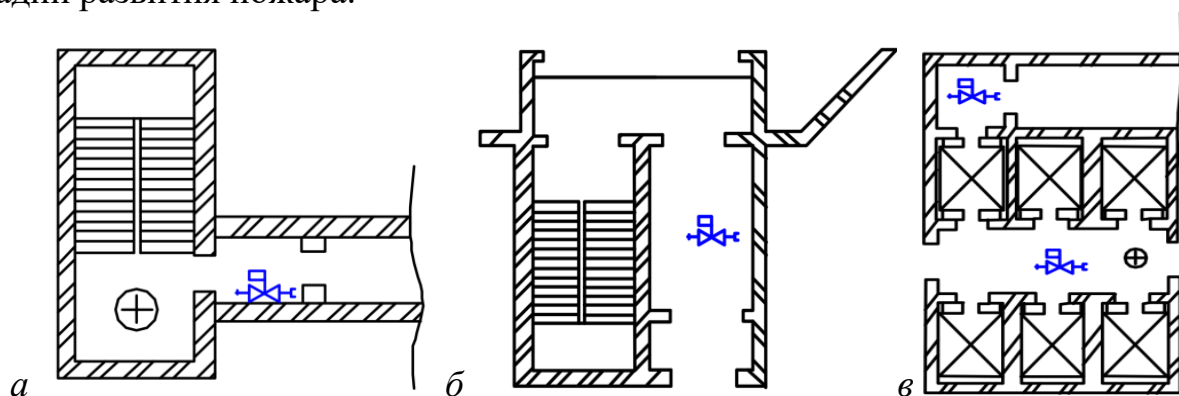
Варианты размещения пожарного стояка в плане этажа высотных жилых зданий:
